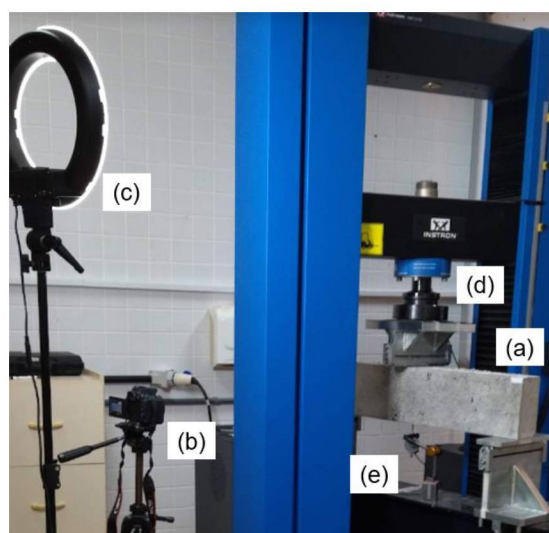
Procedimento de ensaio. a) viga simplesmente apoiada, b) câmera Canon, c) luzes refletoras, d) prensa INSTRON e, e) LVDT
